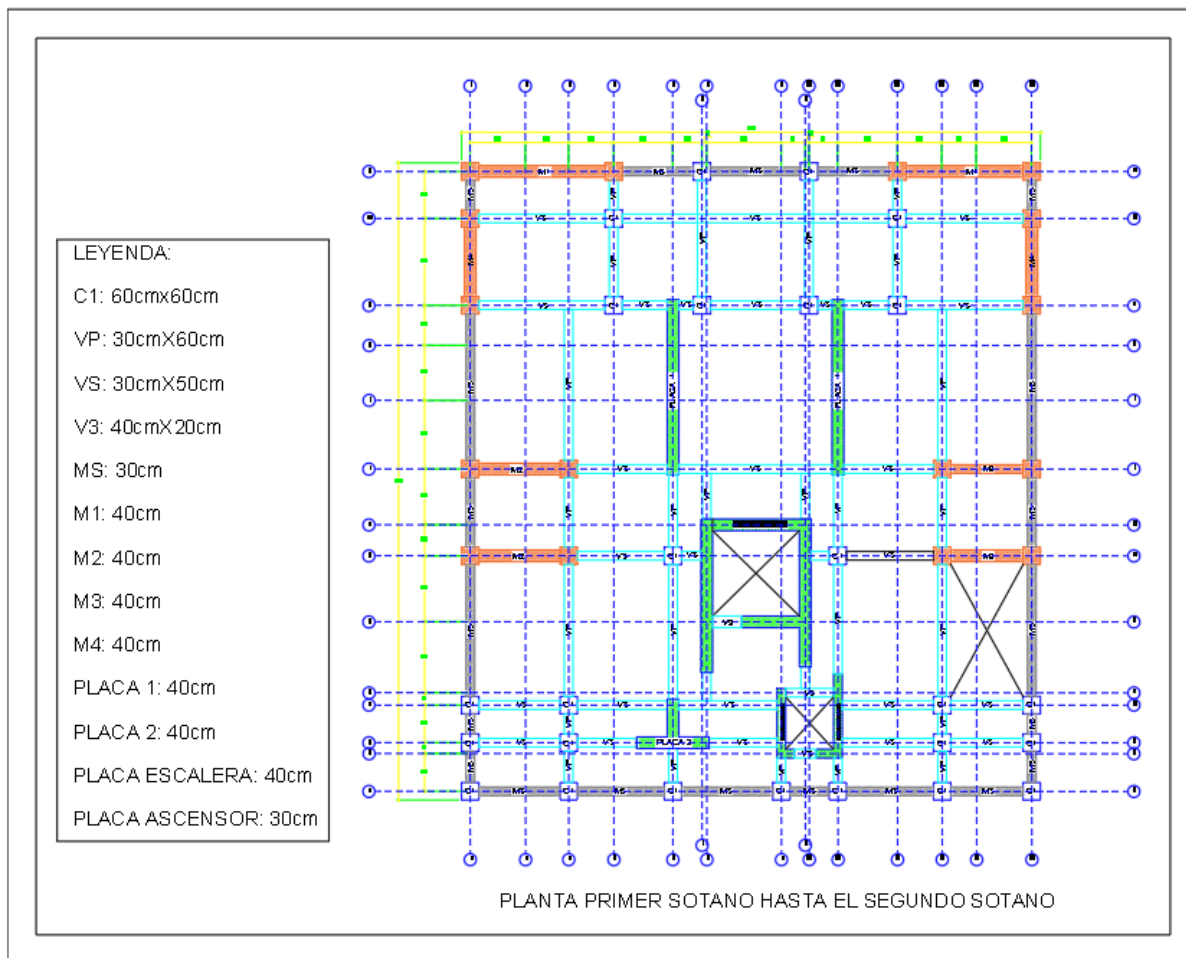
Plano de Estructuras Planta Sótano 1 – Sótano 2.
